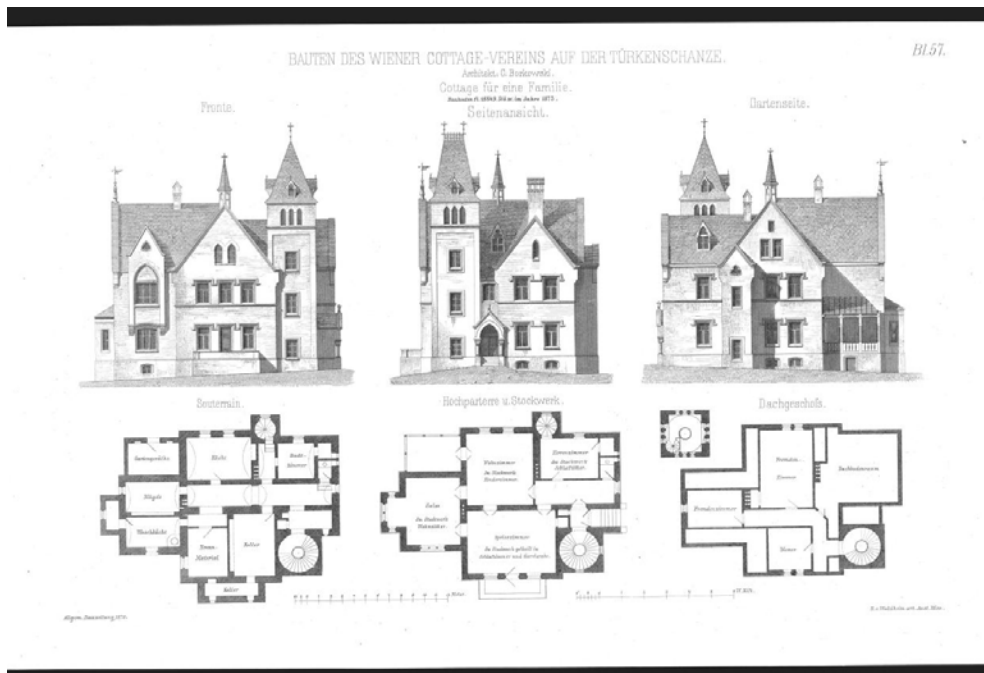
Villa im Cottage Grundriss und Aufriss
